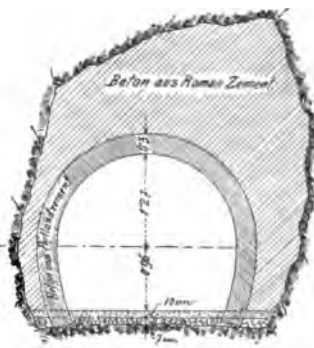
Querschnitt des Beacon Street-Tunnels.
